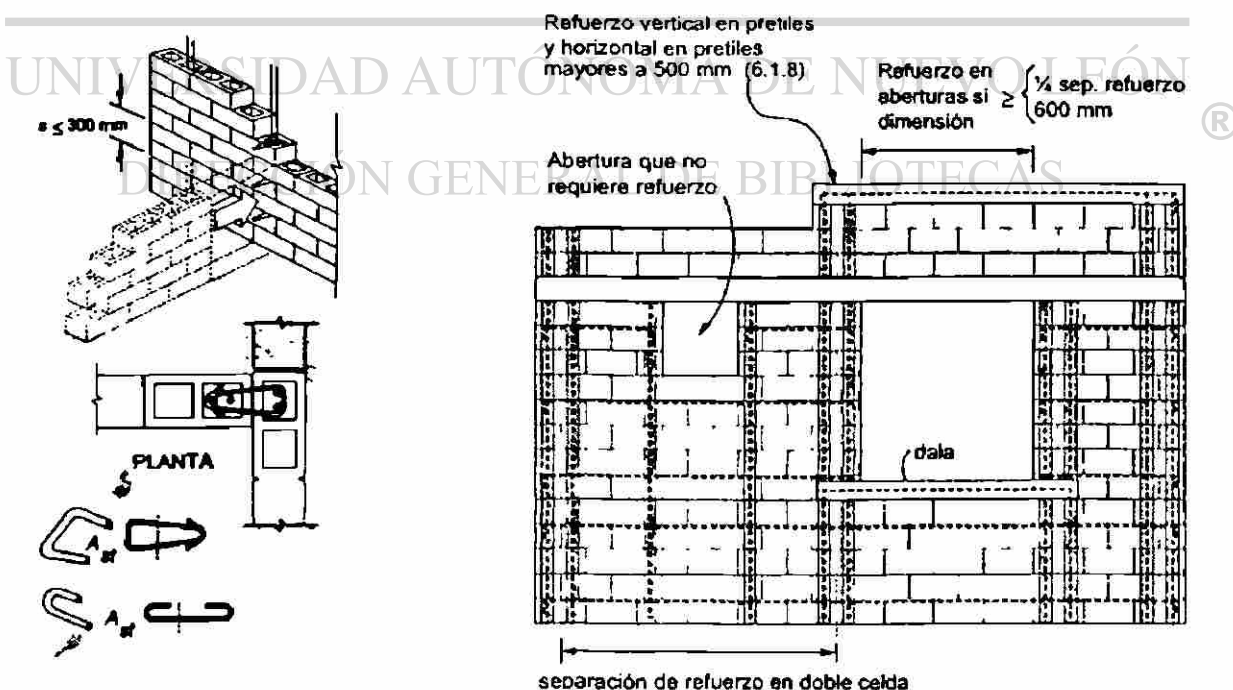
Conectores y refuerzo en aberturas y pretilas.
